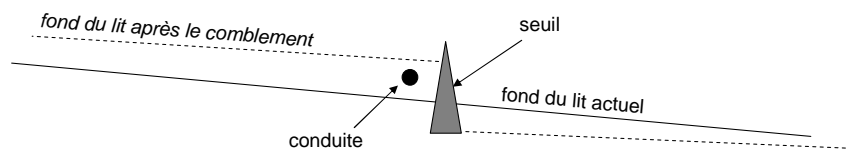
construction d'un seuil pour recouvrir la conduite AEP
